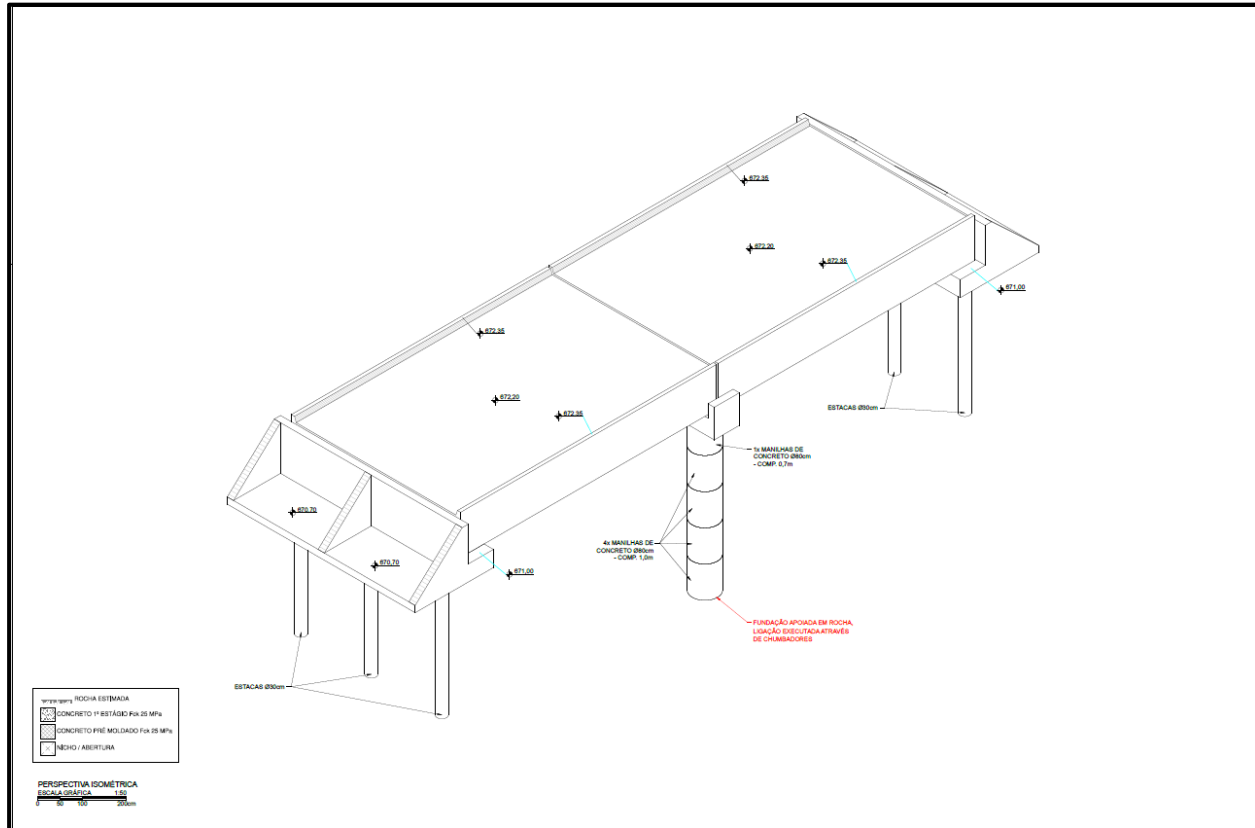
Projeto executivo ponte sobre o canal adutor.
